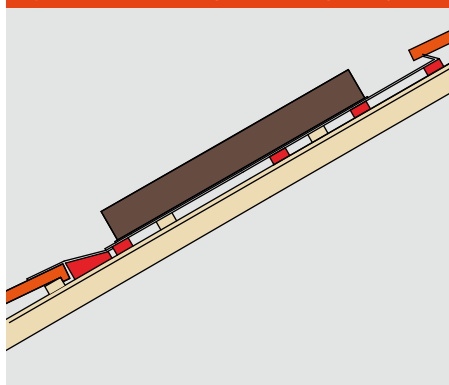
Montaż na dachu z wykorzystaniem klamer dachowych lub haków
